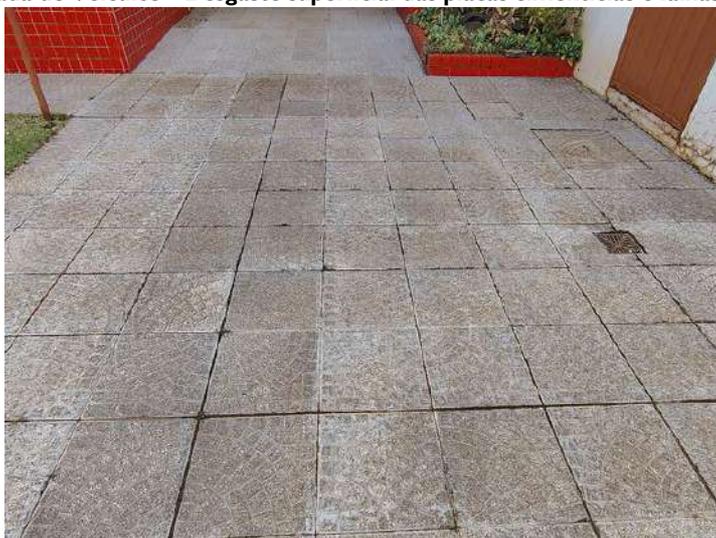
Entrada de Veículos – Desgaste superficial das placas cimentícias e falhas no rejuntamento
